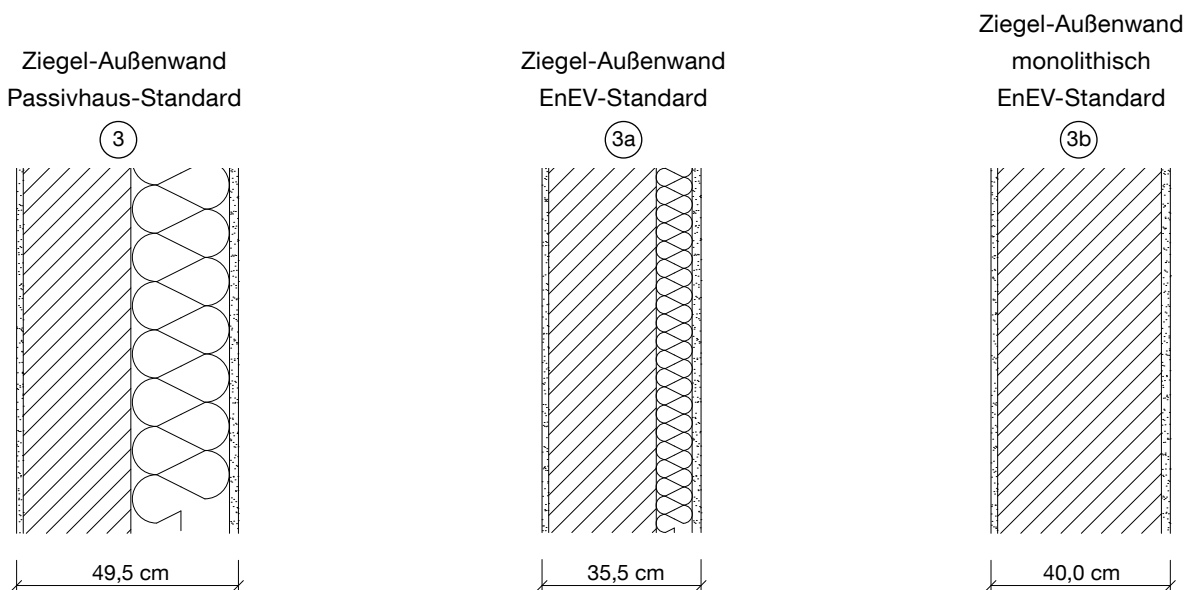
Alternative Außenwandaufbauten in Ziegelbauweise
